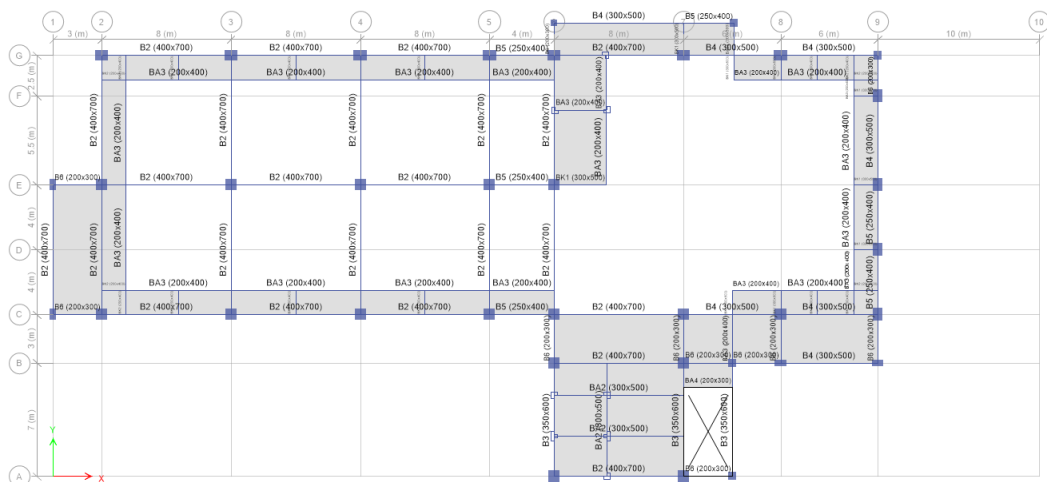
Denah Lantai 4 (EL. +12.00)
